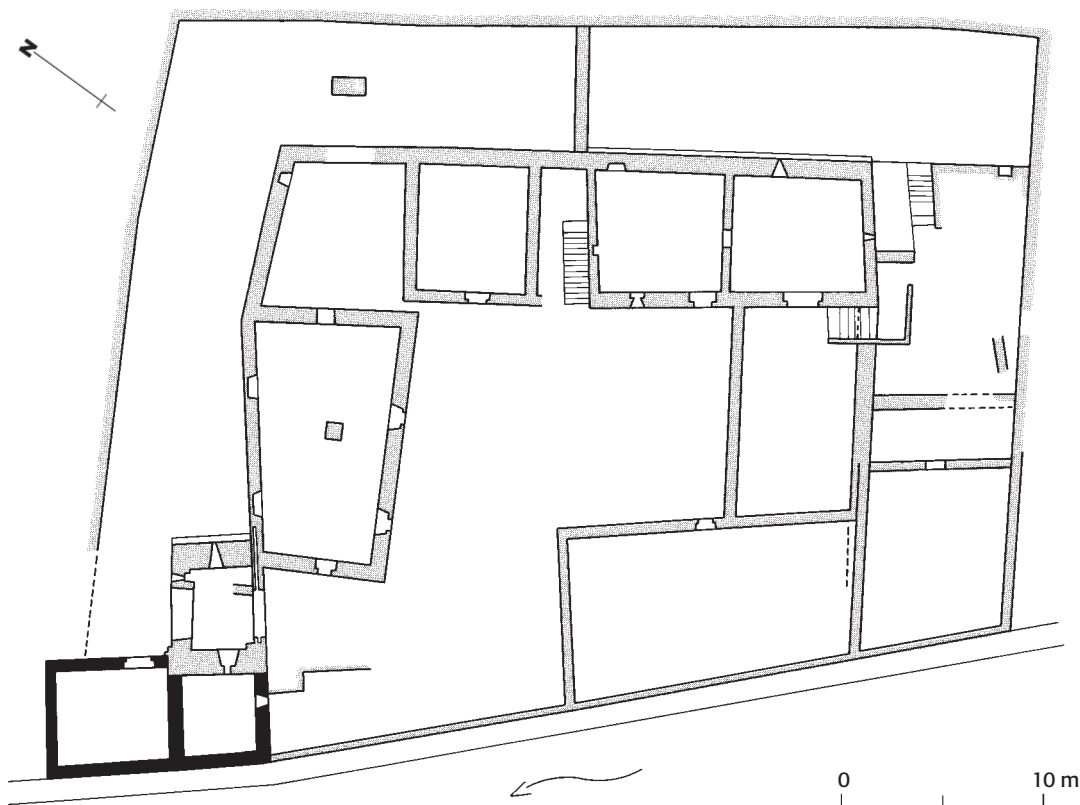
Roveredo, Palazzo Trivulzio, Grundriss. Schwarz gekennzeichnet das Zweiraumwohnhaus Raveglia.
